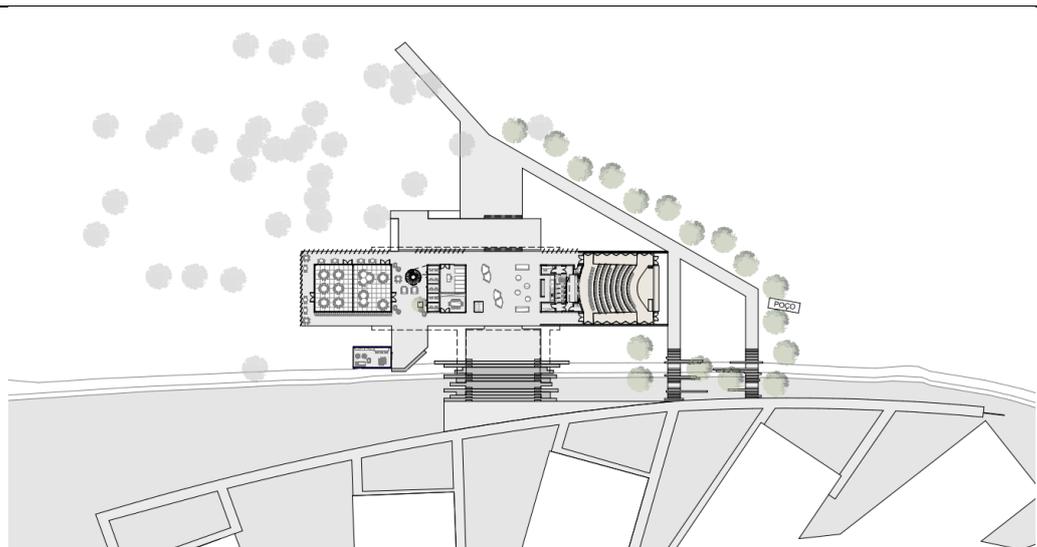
Implantação do Centro de Vivência Ilum (conceitual)
